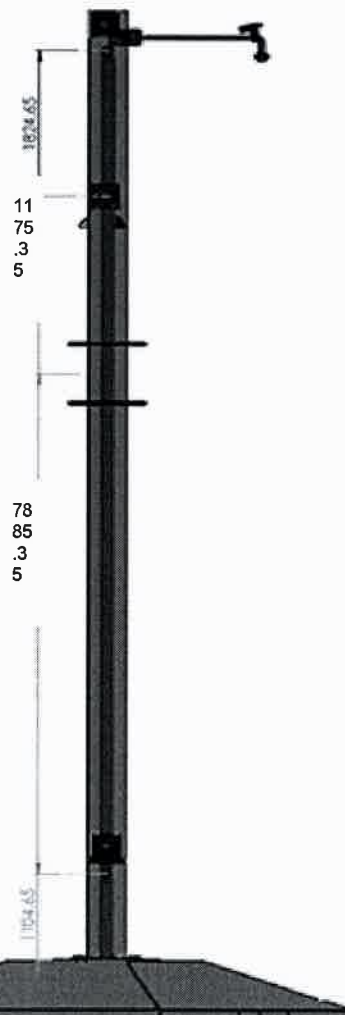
Esquema de Instalación de Tubo Conduit de 4"Ø
